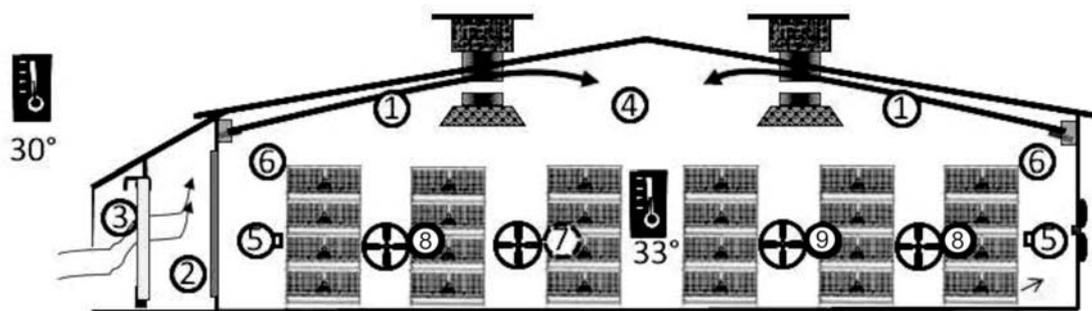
Ventilation latérale avec entrée d'air toit
